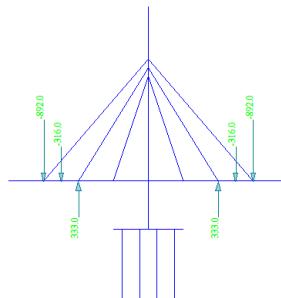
49 Permodelan saat Construction Stage 9 (CS 9)
